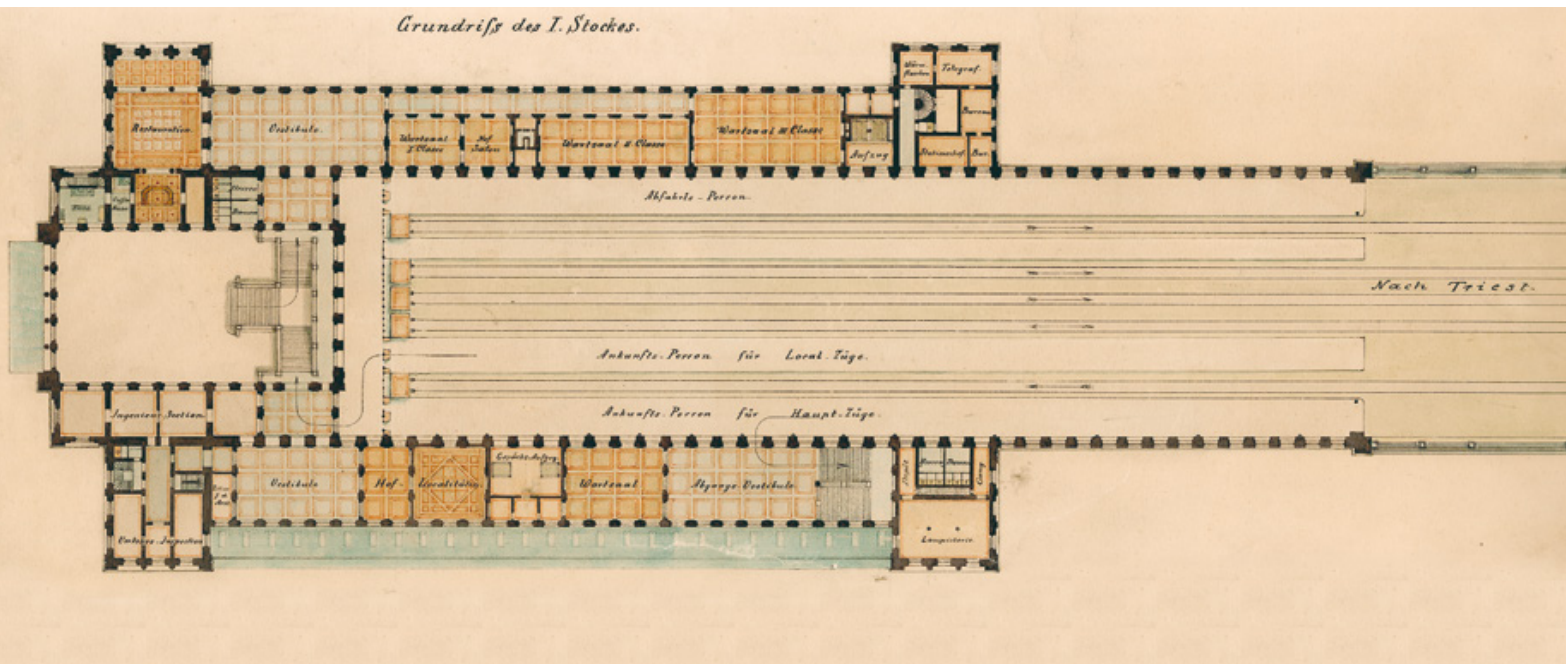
Südbahnhof, Grundriß des 1. Stockes mit „Ankunftsperron der Localzüge und Hauptzüge“, 1869. Wilhelm Flattich. Franz Wilhelm, Tuschfederzeichnung aquarelliert.
